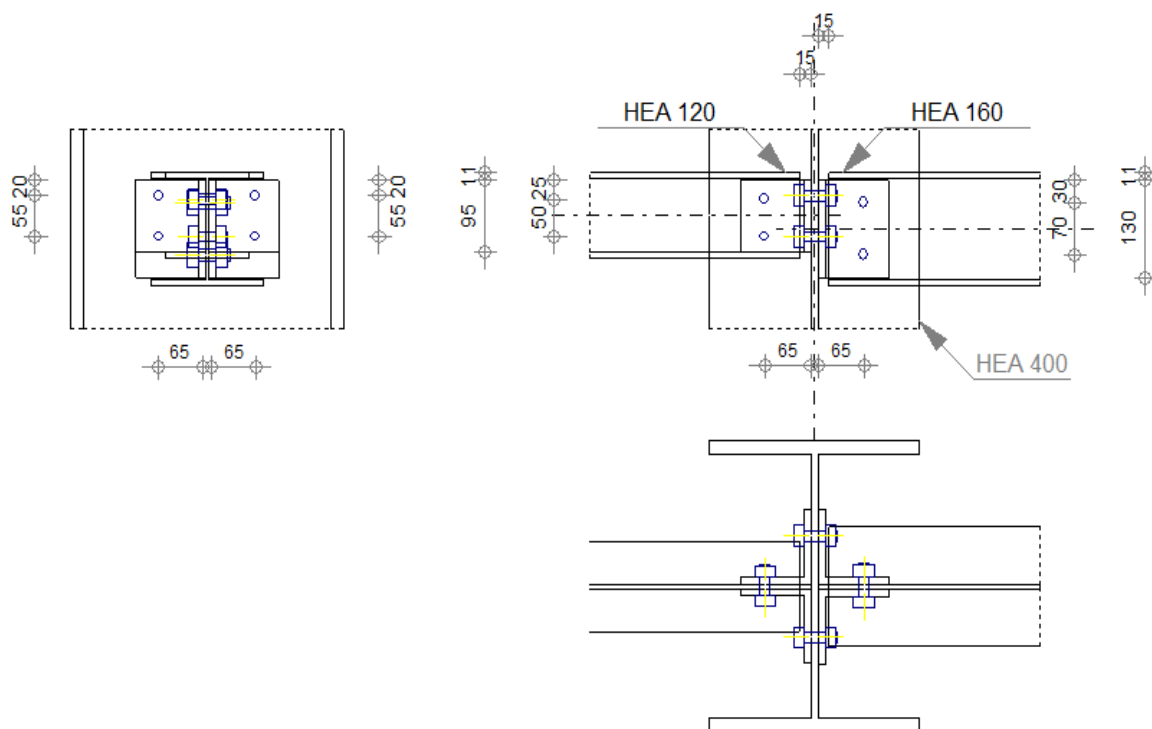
Vue en plan de l'assemblage Poteau-deux Poutre sablière (HEA120 et HEA 160).
